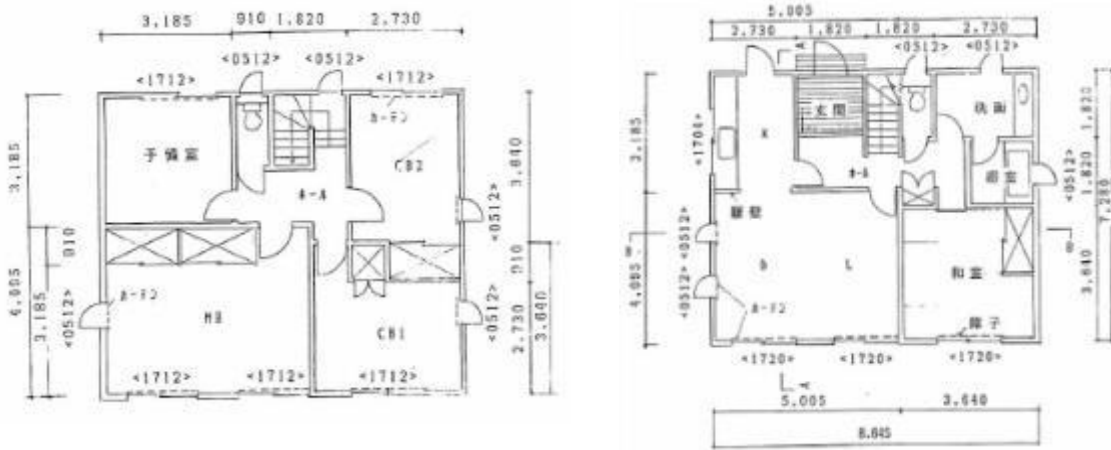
日本建築学会標準住宅モデル(木造)平面図
